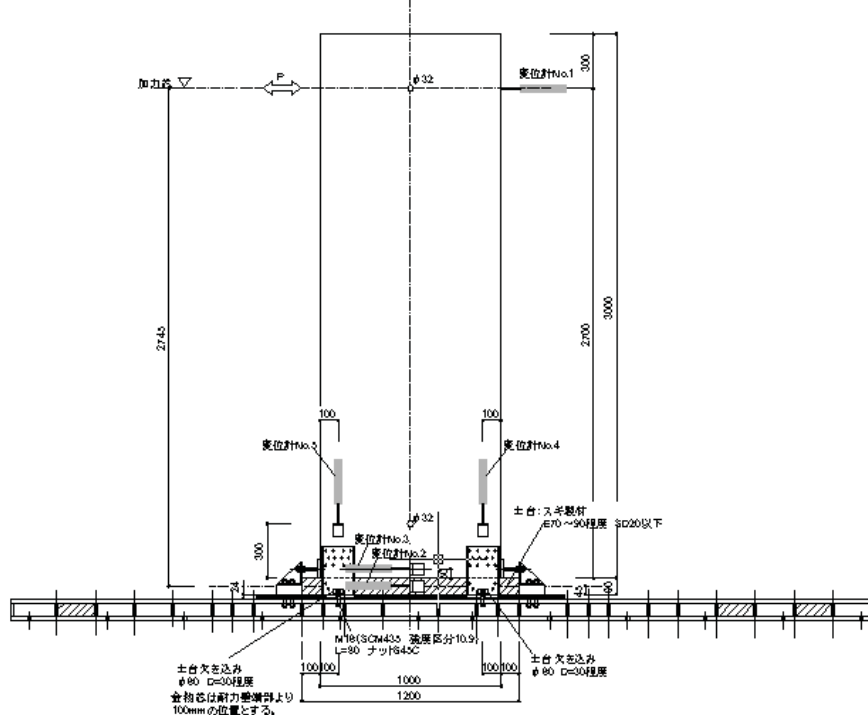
L 型ビス用金物 (1m 幅耐力壁) 試験体立面図 (L1-1)
